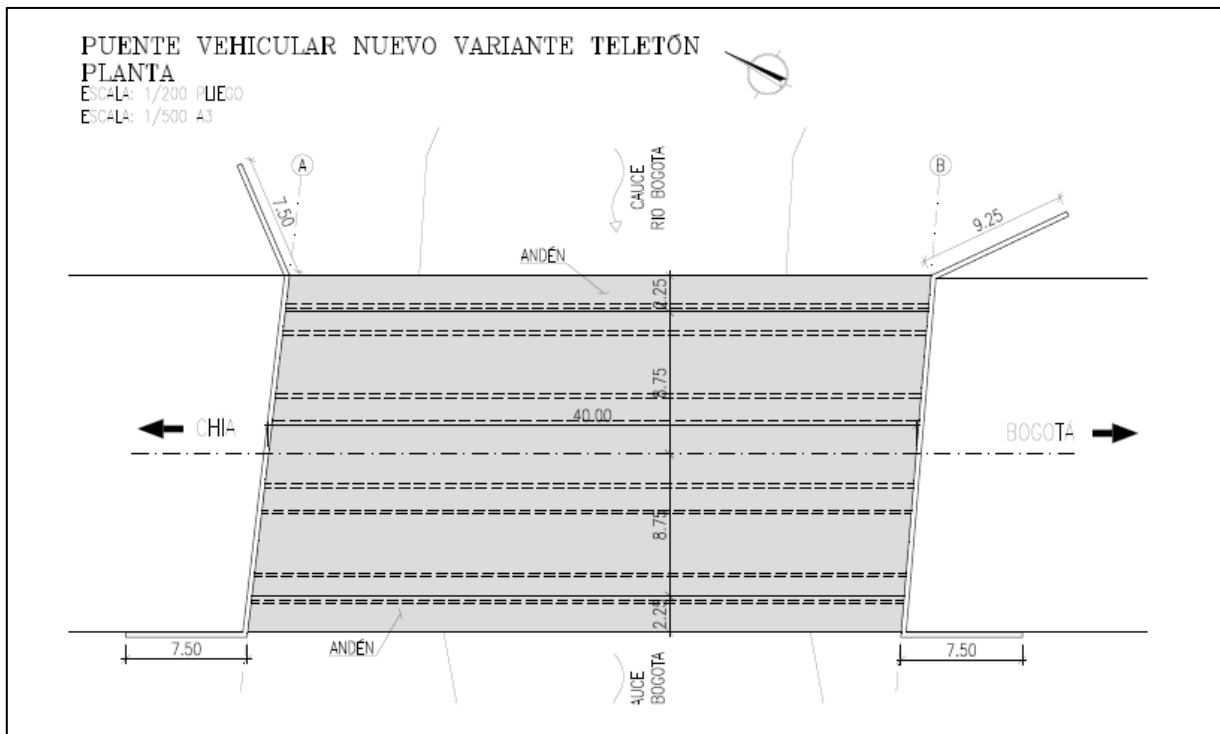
Vista en Planta Puente Rio Bogotá Nuevo
